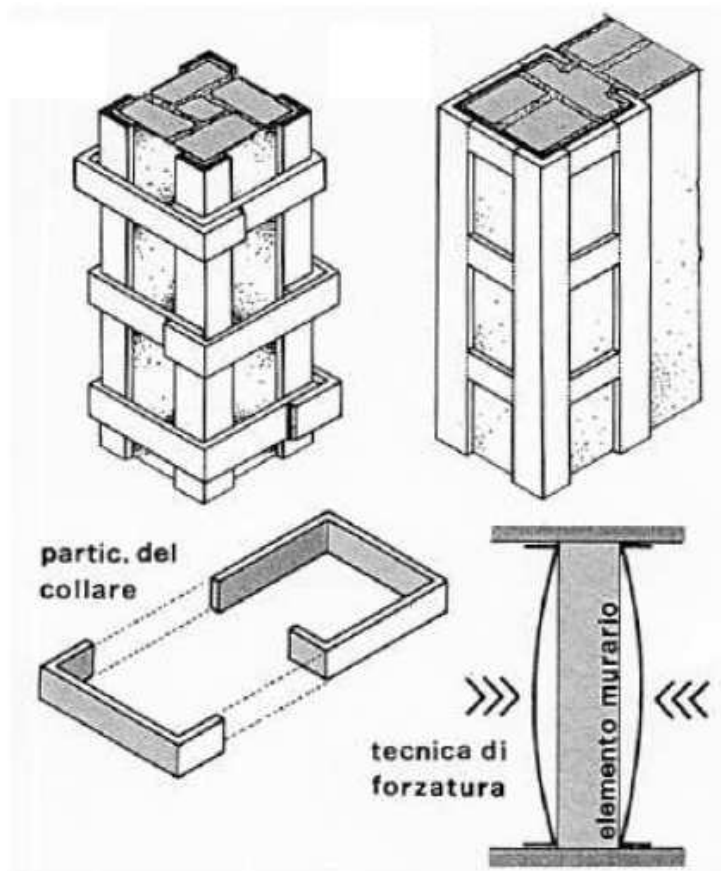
Cerchiatura di pilastri in muratura di mattoni
